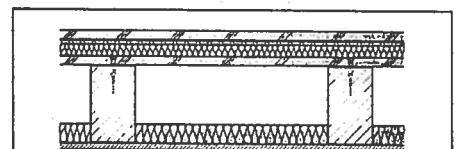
+ 10: Holzbalkendecken mit verdeckter bzw. teilweise sichtbarer Balkenlage und Hawaphon-Beschwerung.
